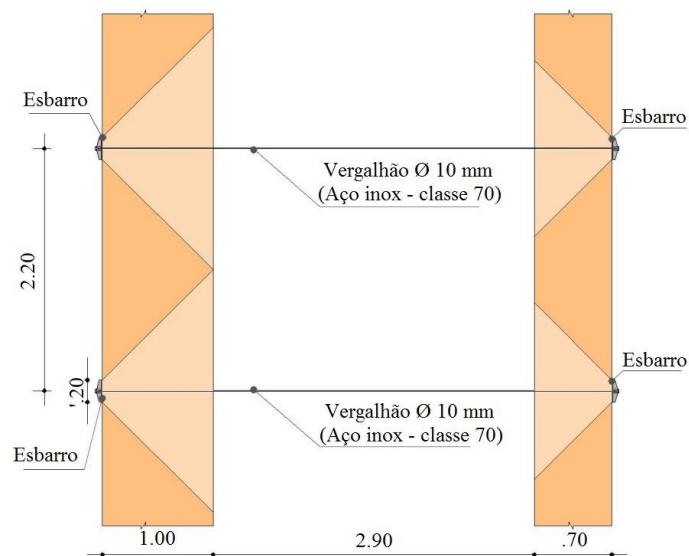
Esquema representativo do espaçamento dos tirantes, em planta (dimensões em metros).
